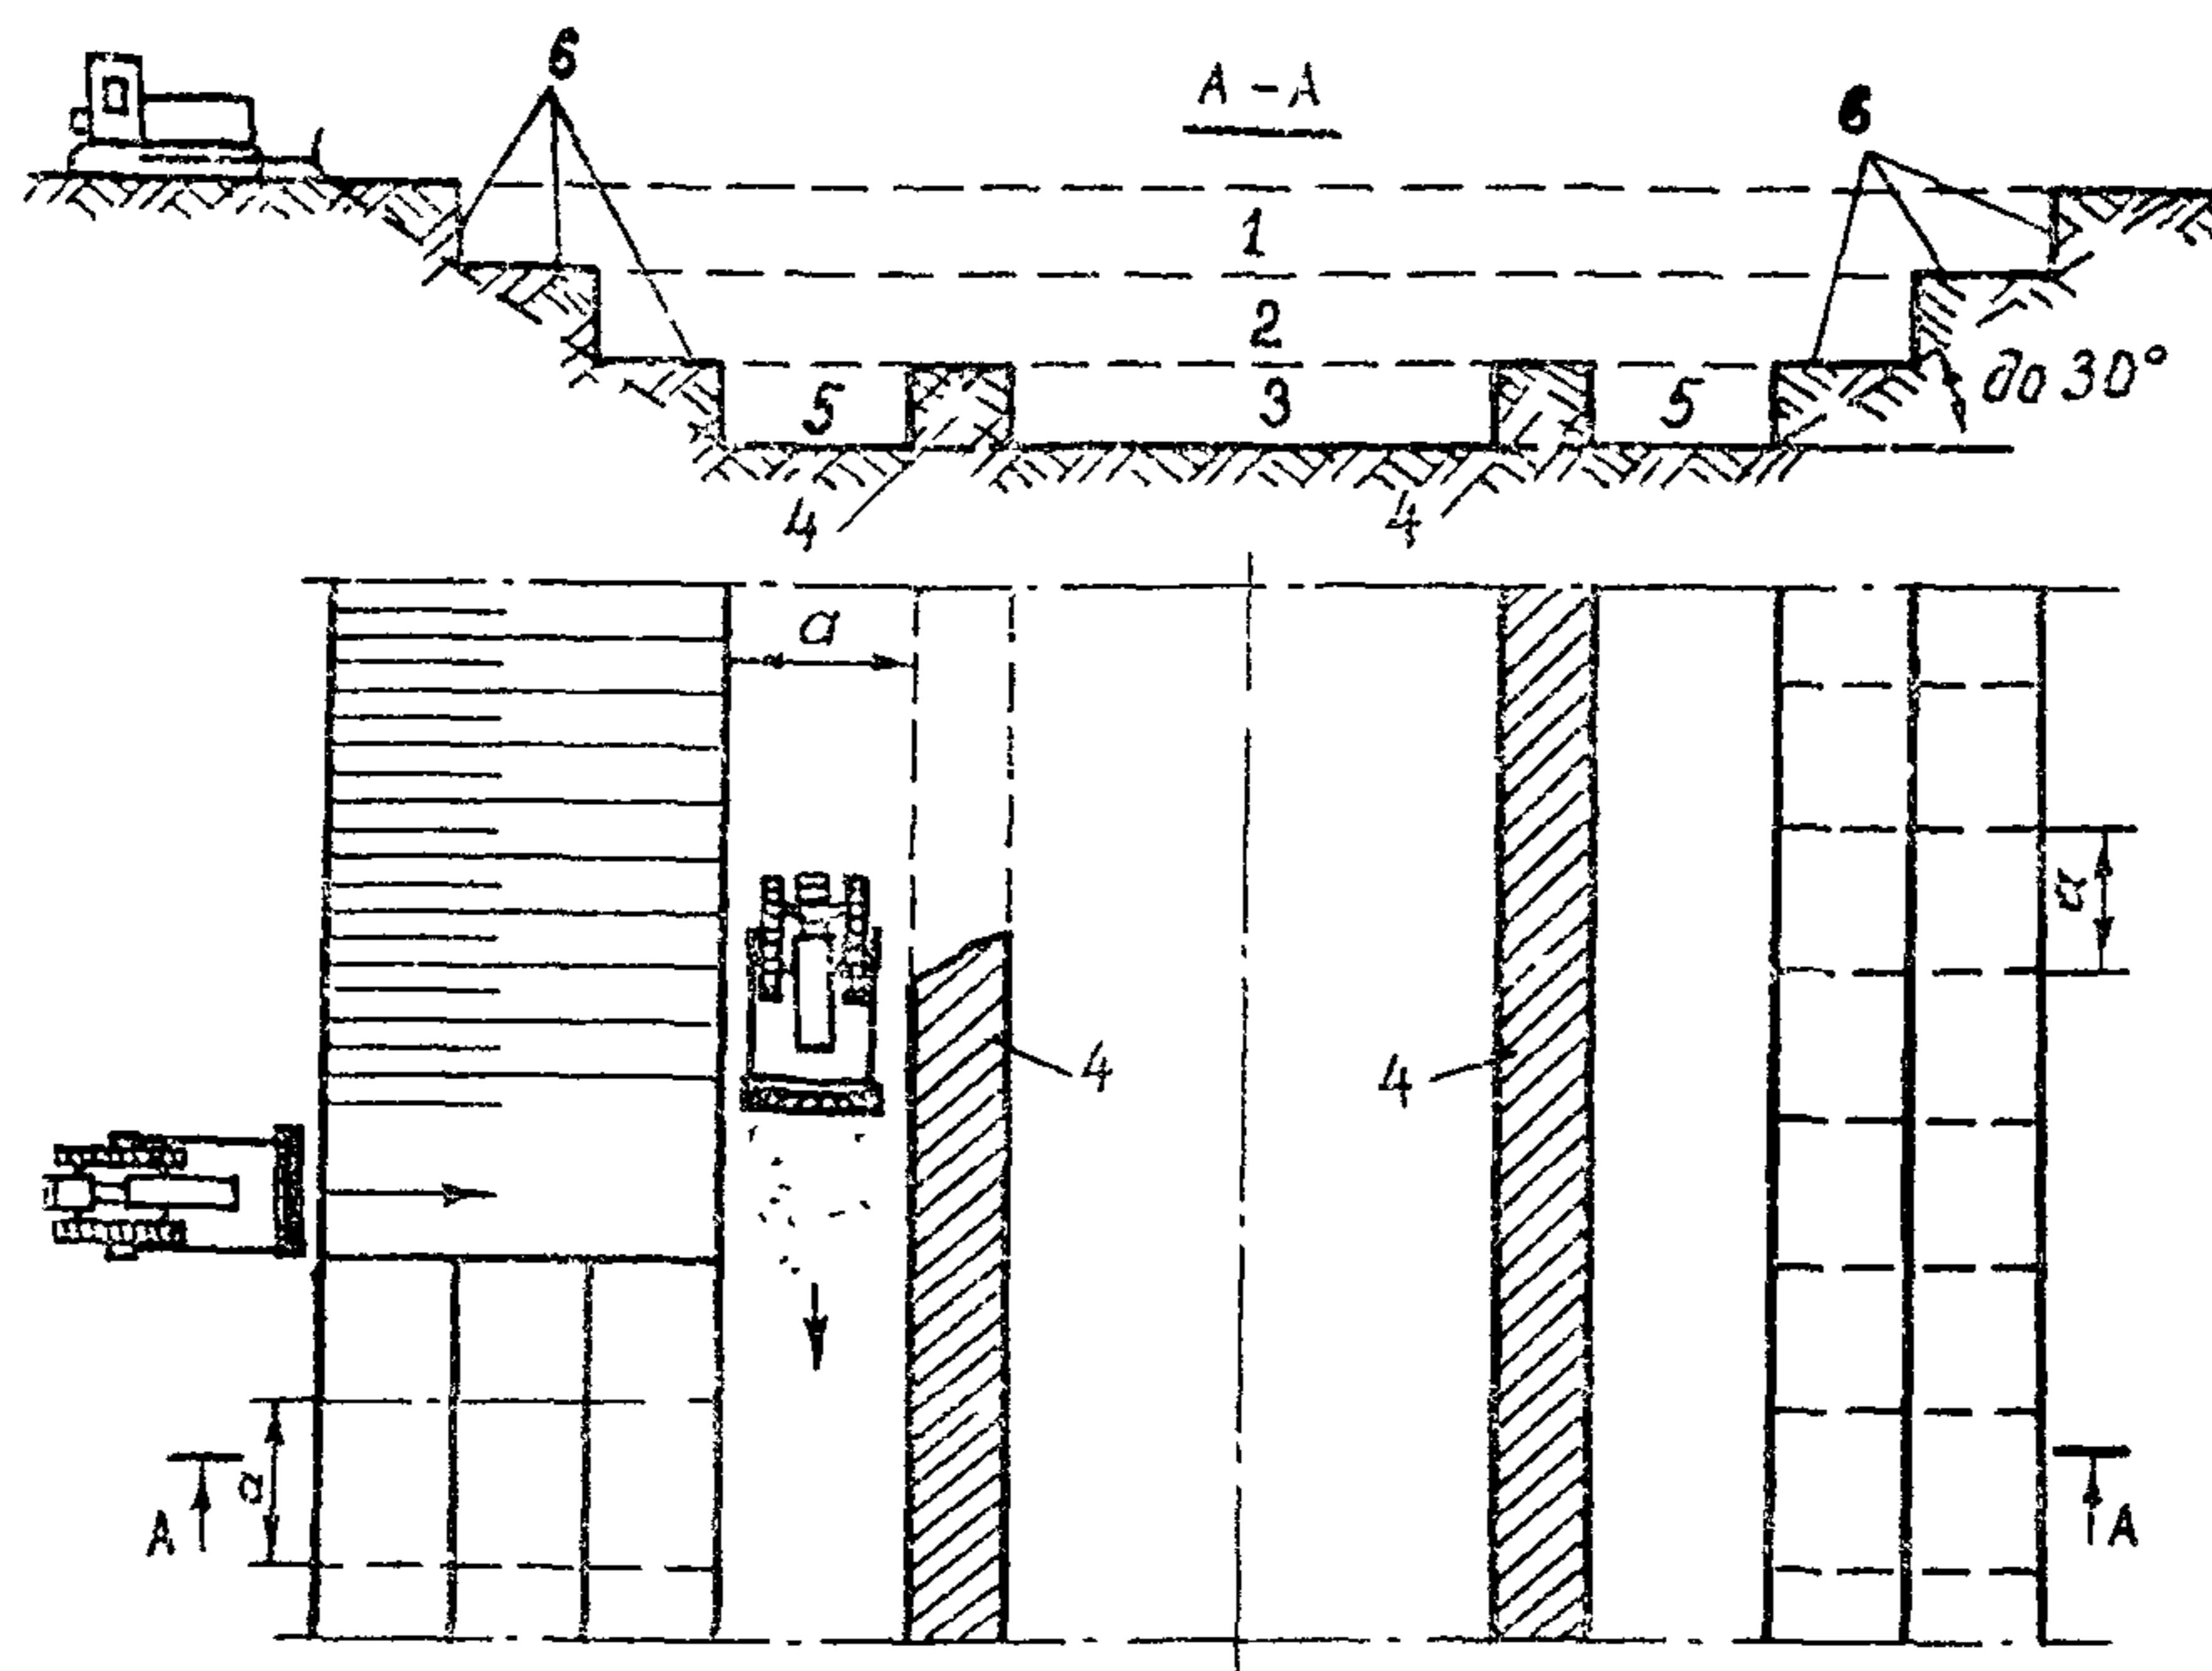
Схема разработки бульдозером грунта вблизи откосов выемки:
